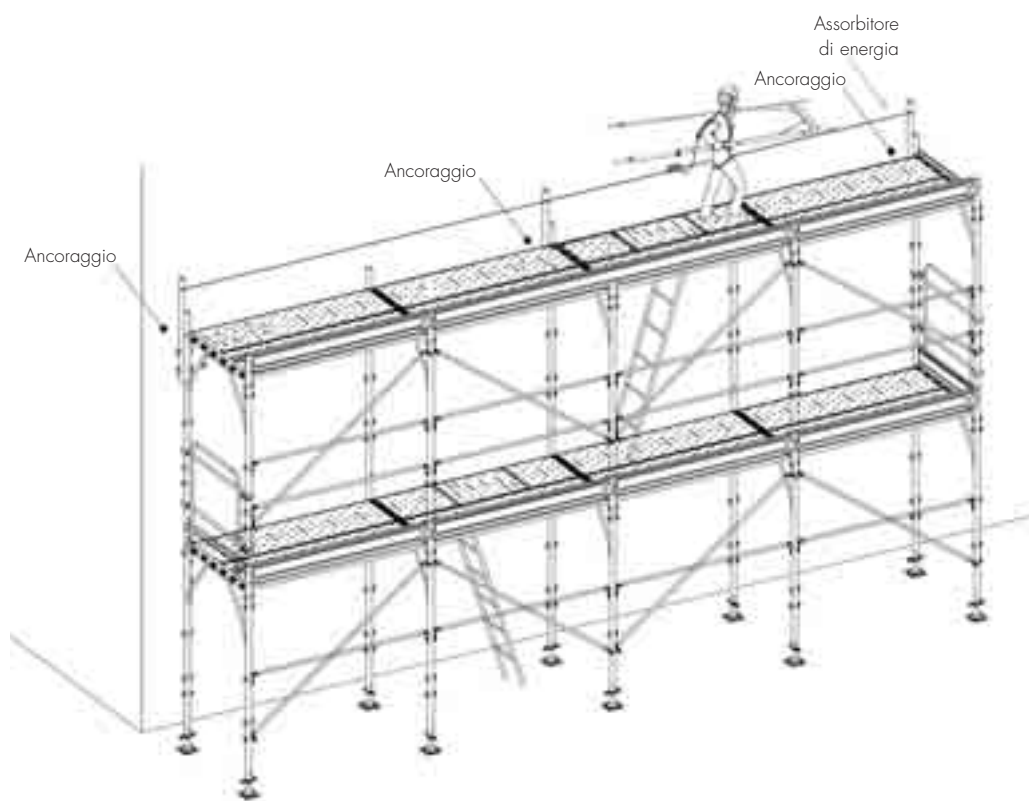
Fase operativa di montaggio del terzo livello: linea di ancoraggio posta ad un livello più elevato rispetto al piano di lavoro
